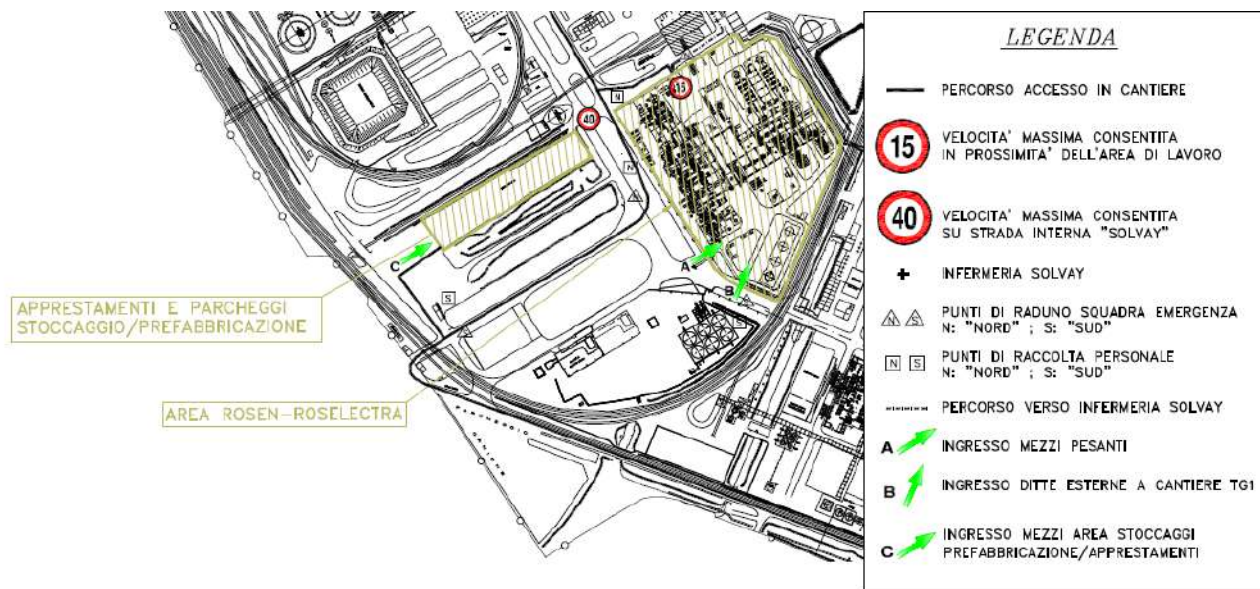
Planimetria generale con riferimenti principali e percorsi per accesso in cantiere (da PSC)
